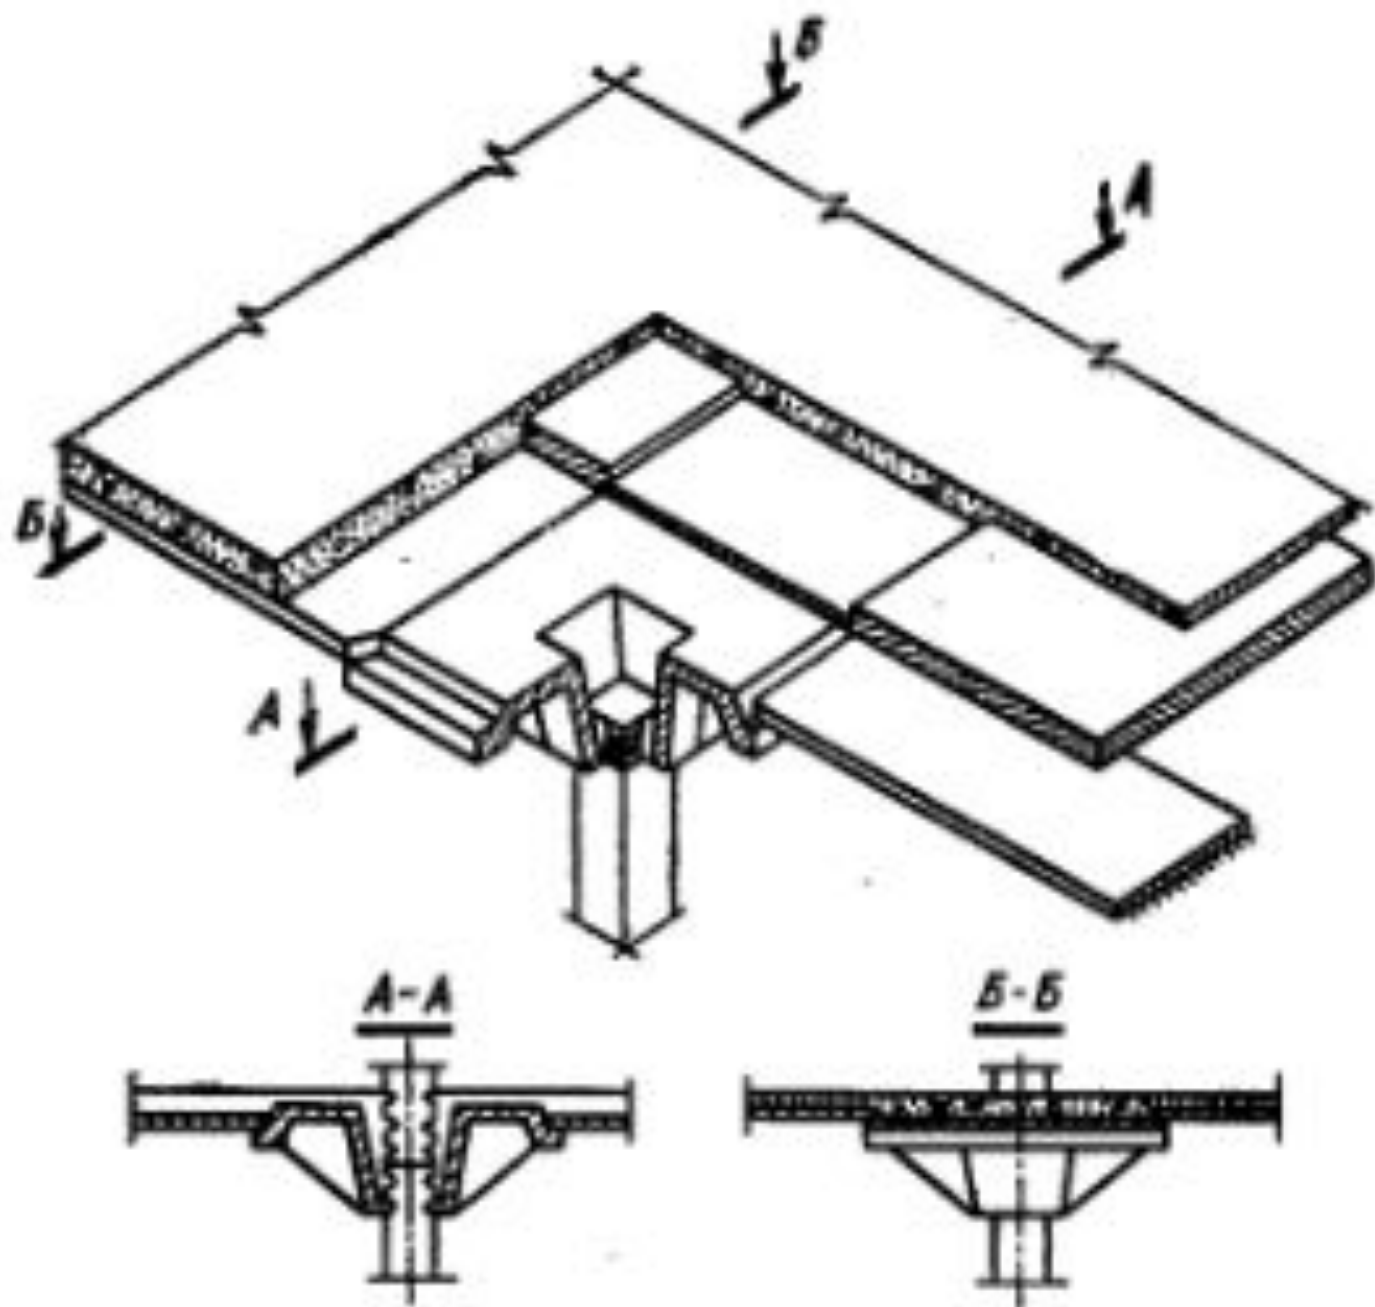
Конструкция безбалочного сборно-монолитного перекрытия
